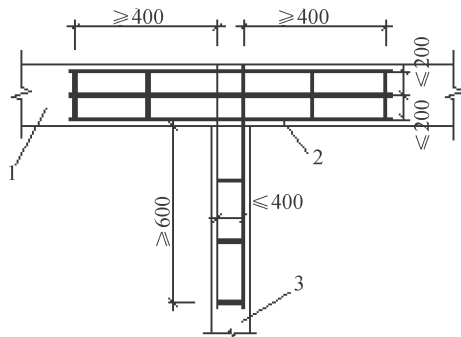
砌块墙与后砌隔墙交接处钢筋网片
